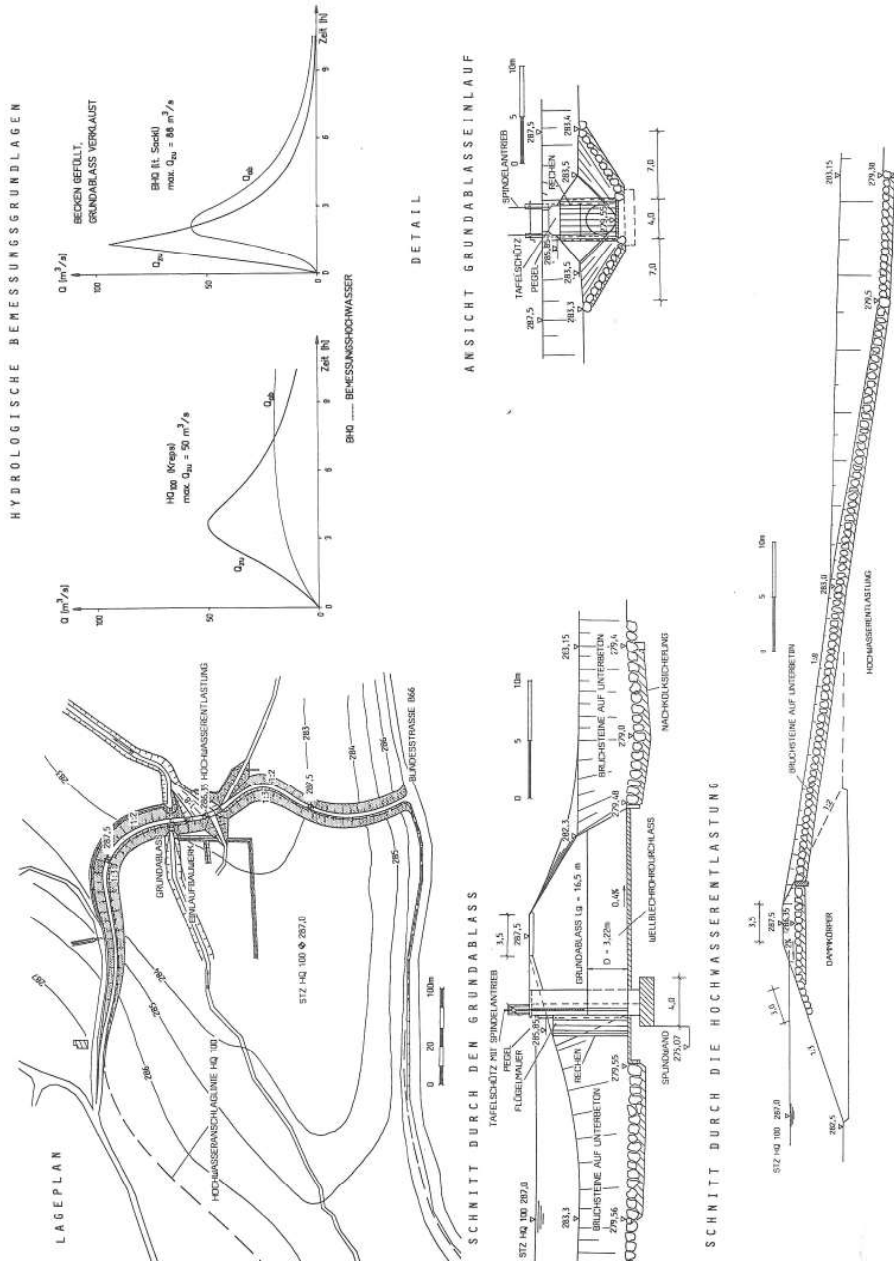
Lageplan und Schnitte, HRB Auersbach
